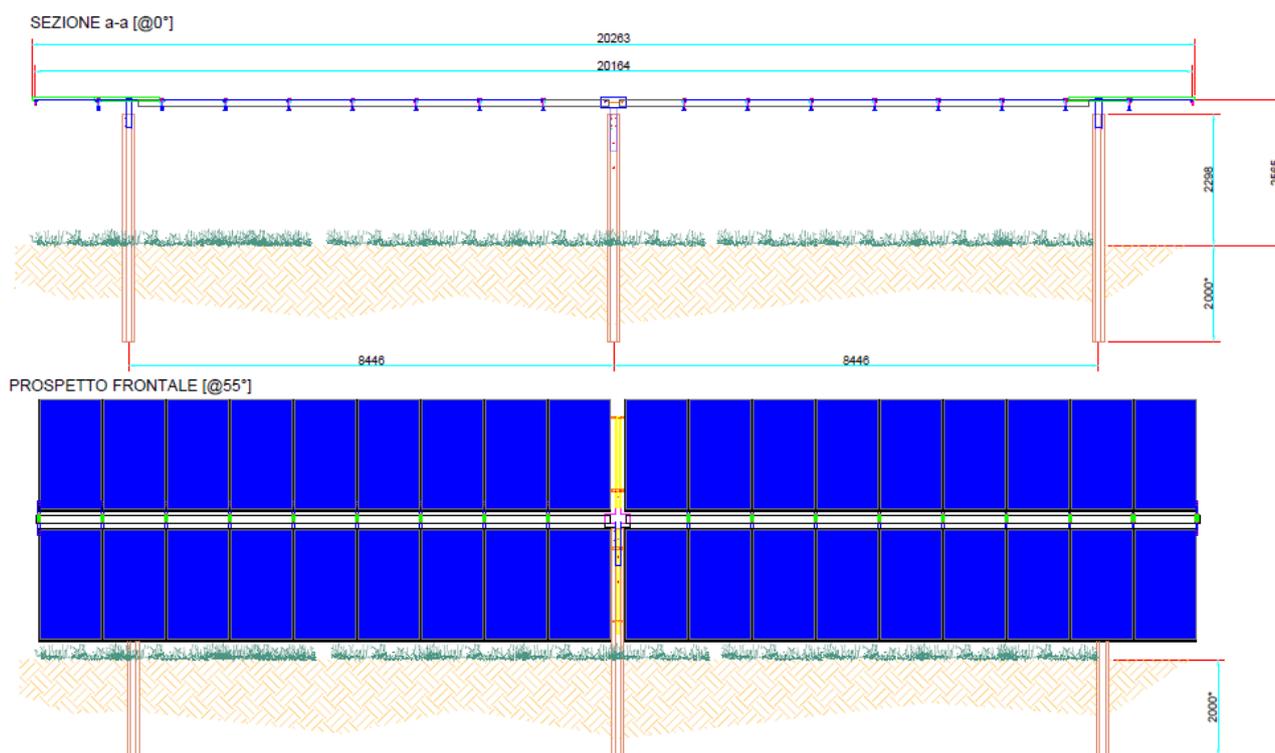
Sezione e prospetto tipo tracker e moduli in progetto.
